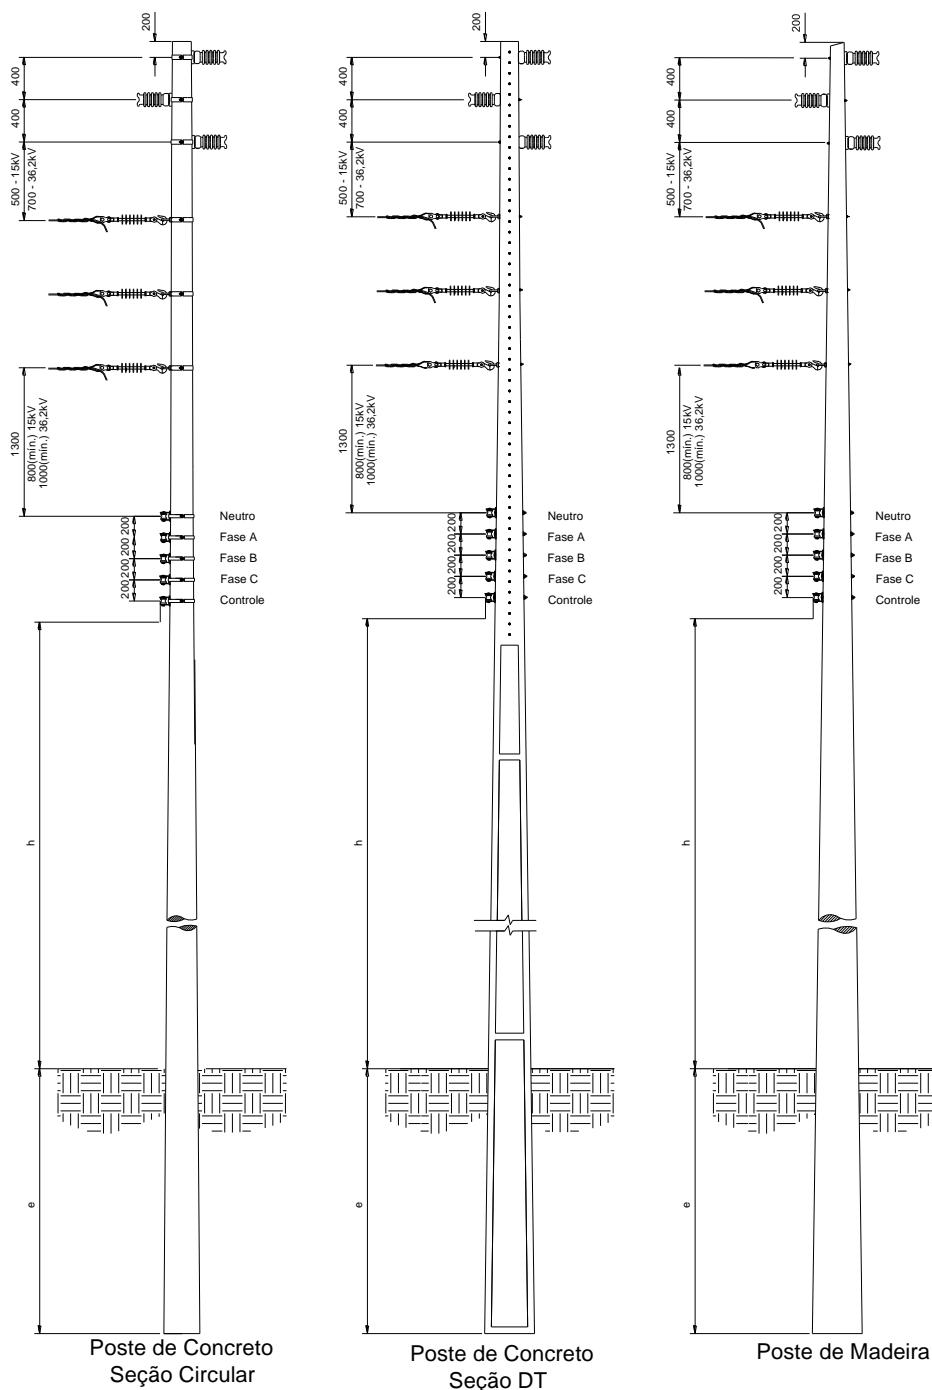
Afastamentos mínimos – Estruturas pilar trifásicas tangentes com derivação pilar
